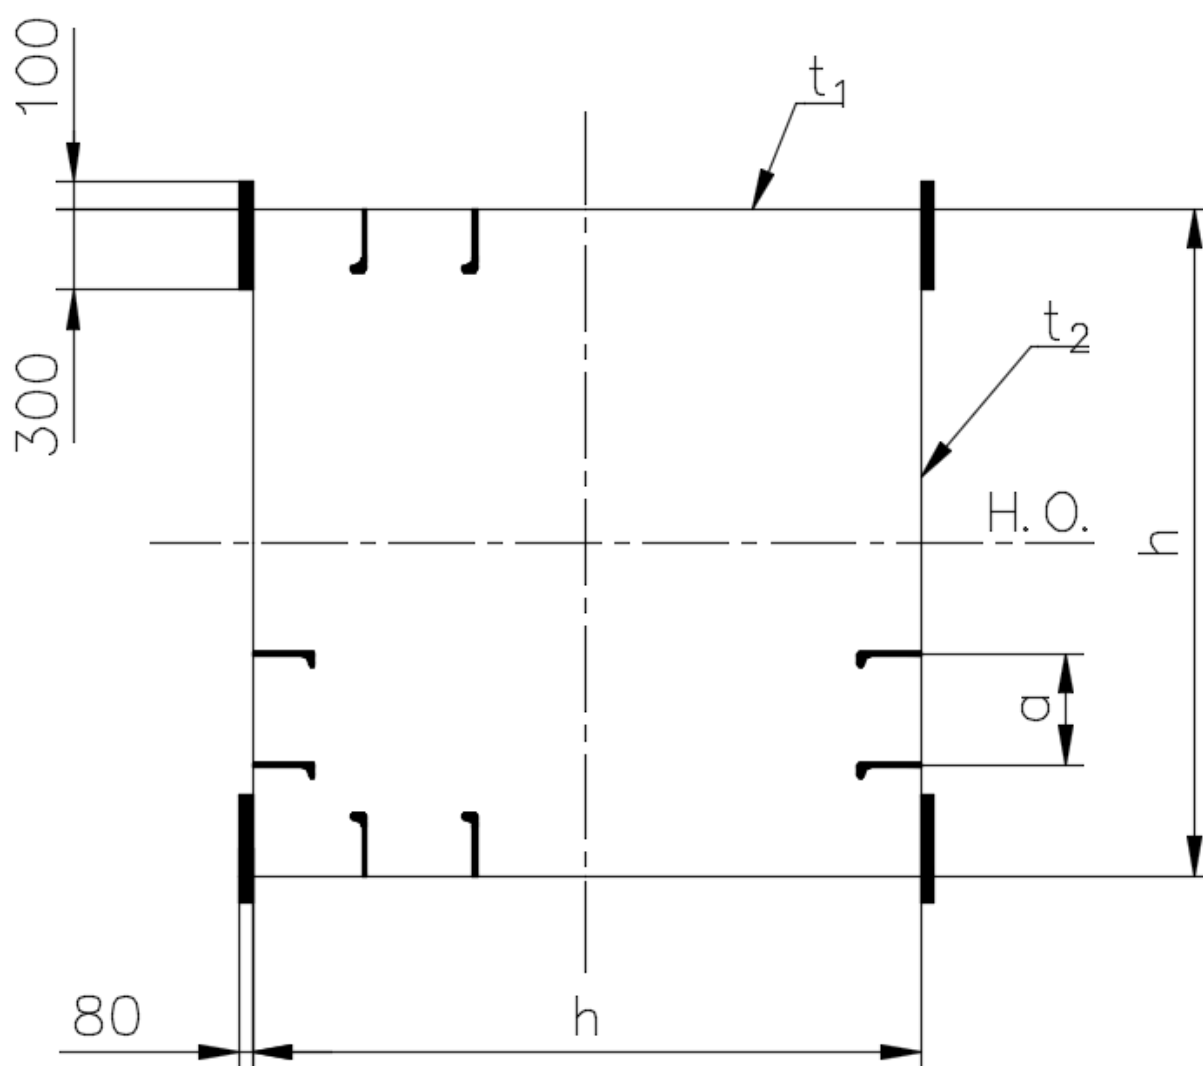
Схема поперечного сечения прямоугольной листовой опорной колоны
